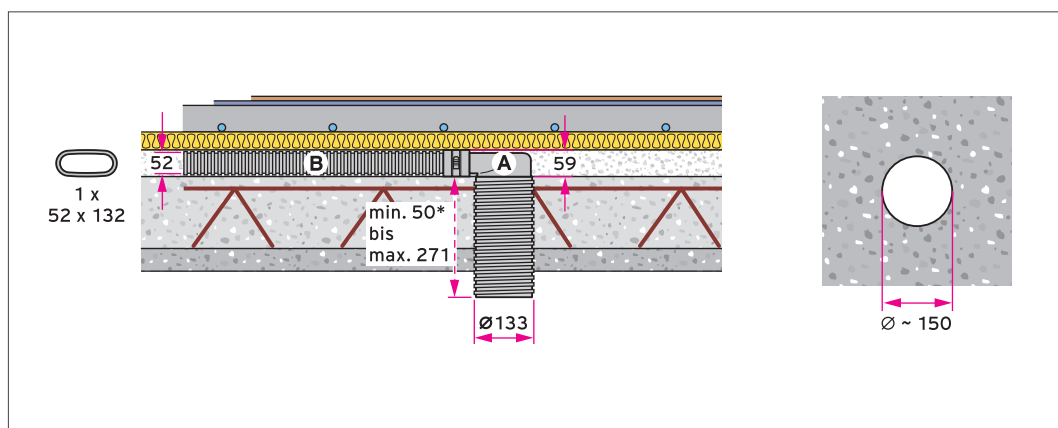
Runder Luftein-/auslass - Verlegung im Fußbodenaufbau
